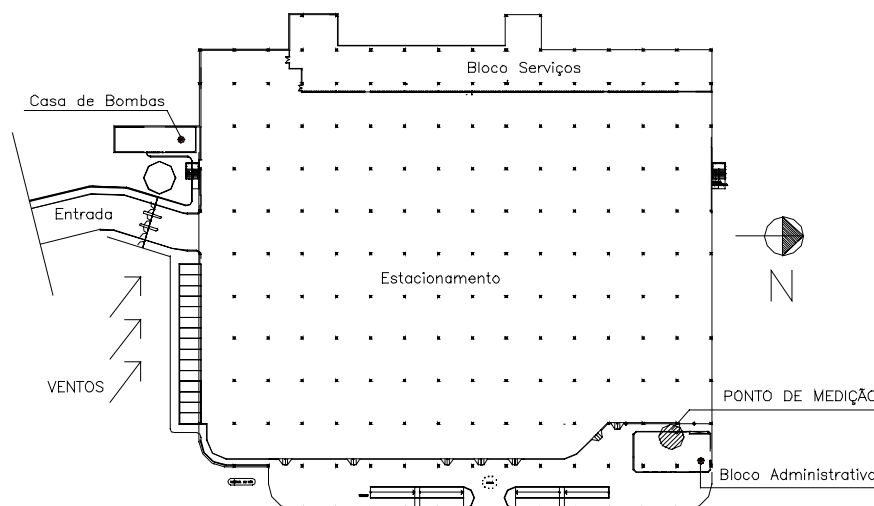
Planta baixa do estacionamento aberto (Sem escala)
